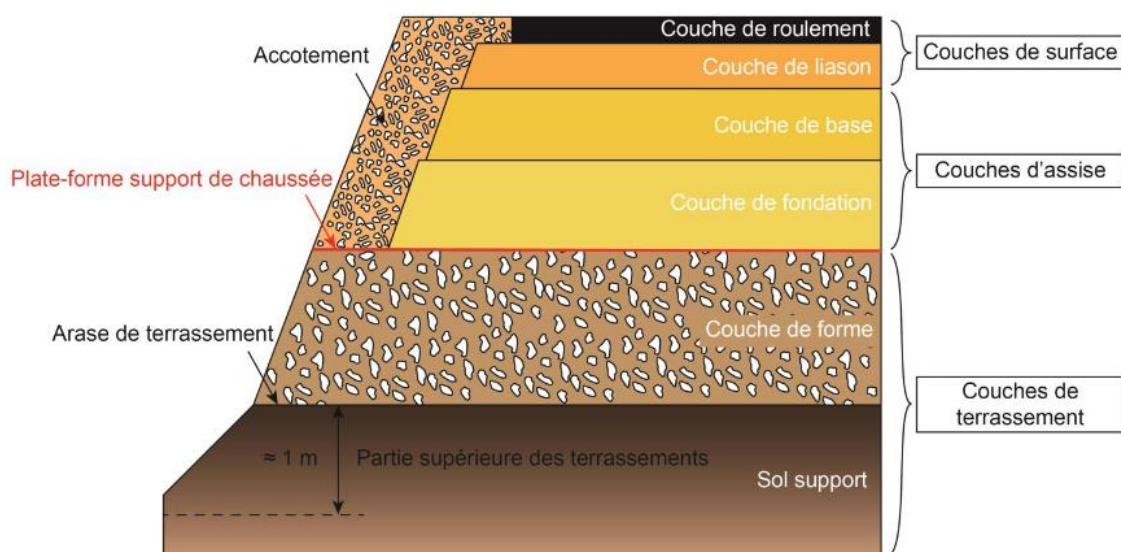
coupe transversale d'une structure type de chaussée (Cerema, 2018)
